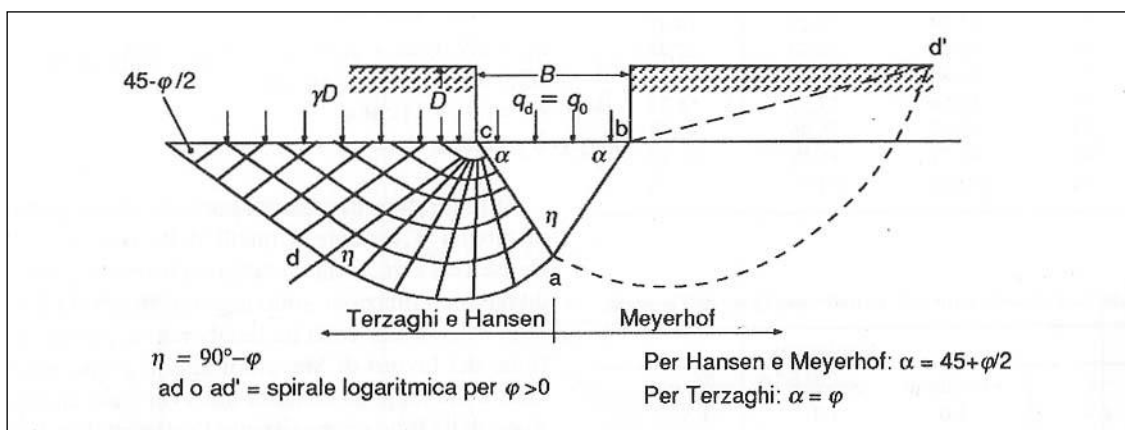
Schema di rottura del terreno sotto la fondazione
